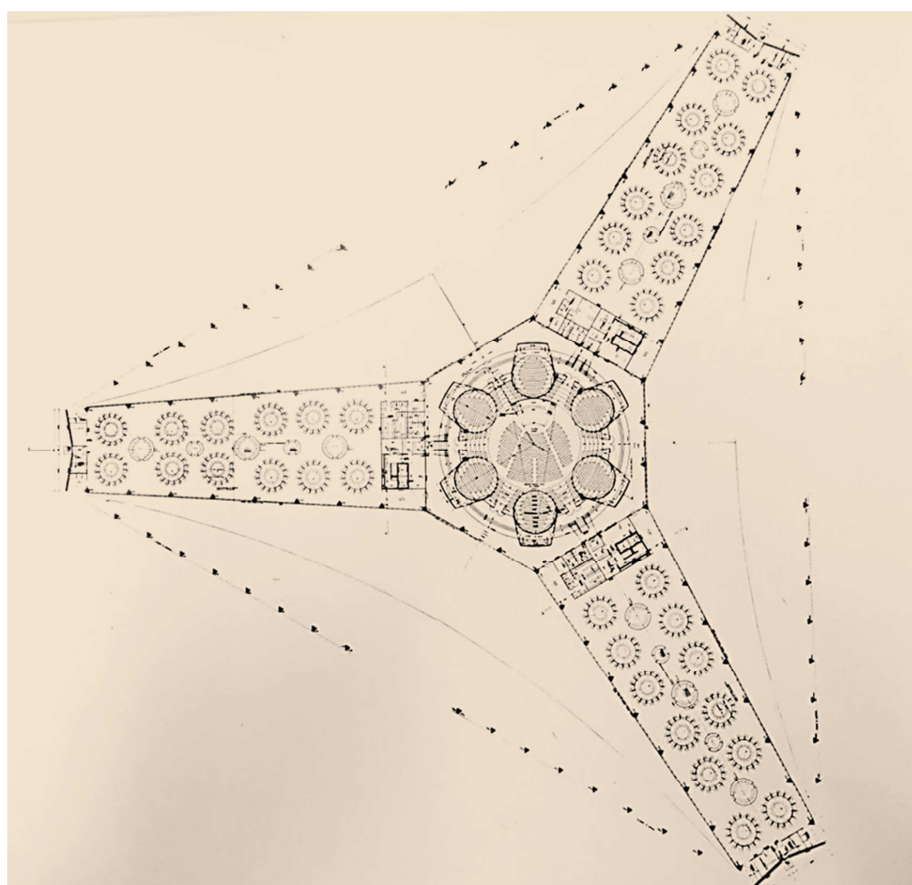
Sergio Bernardes, ESG, DF, 1970/74. Planta 2º Pavimento (Nível + 5).
